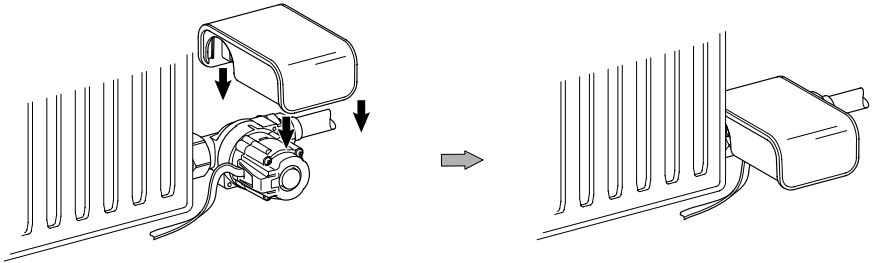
Verkleidung auf Heatfixx Pumpe/Pumpenadapter aufstecken
